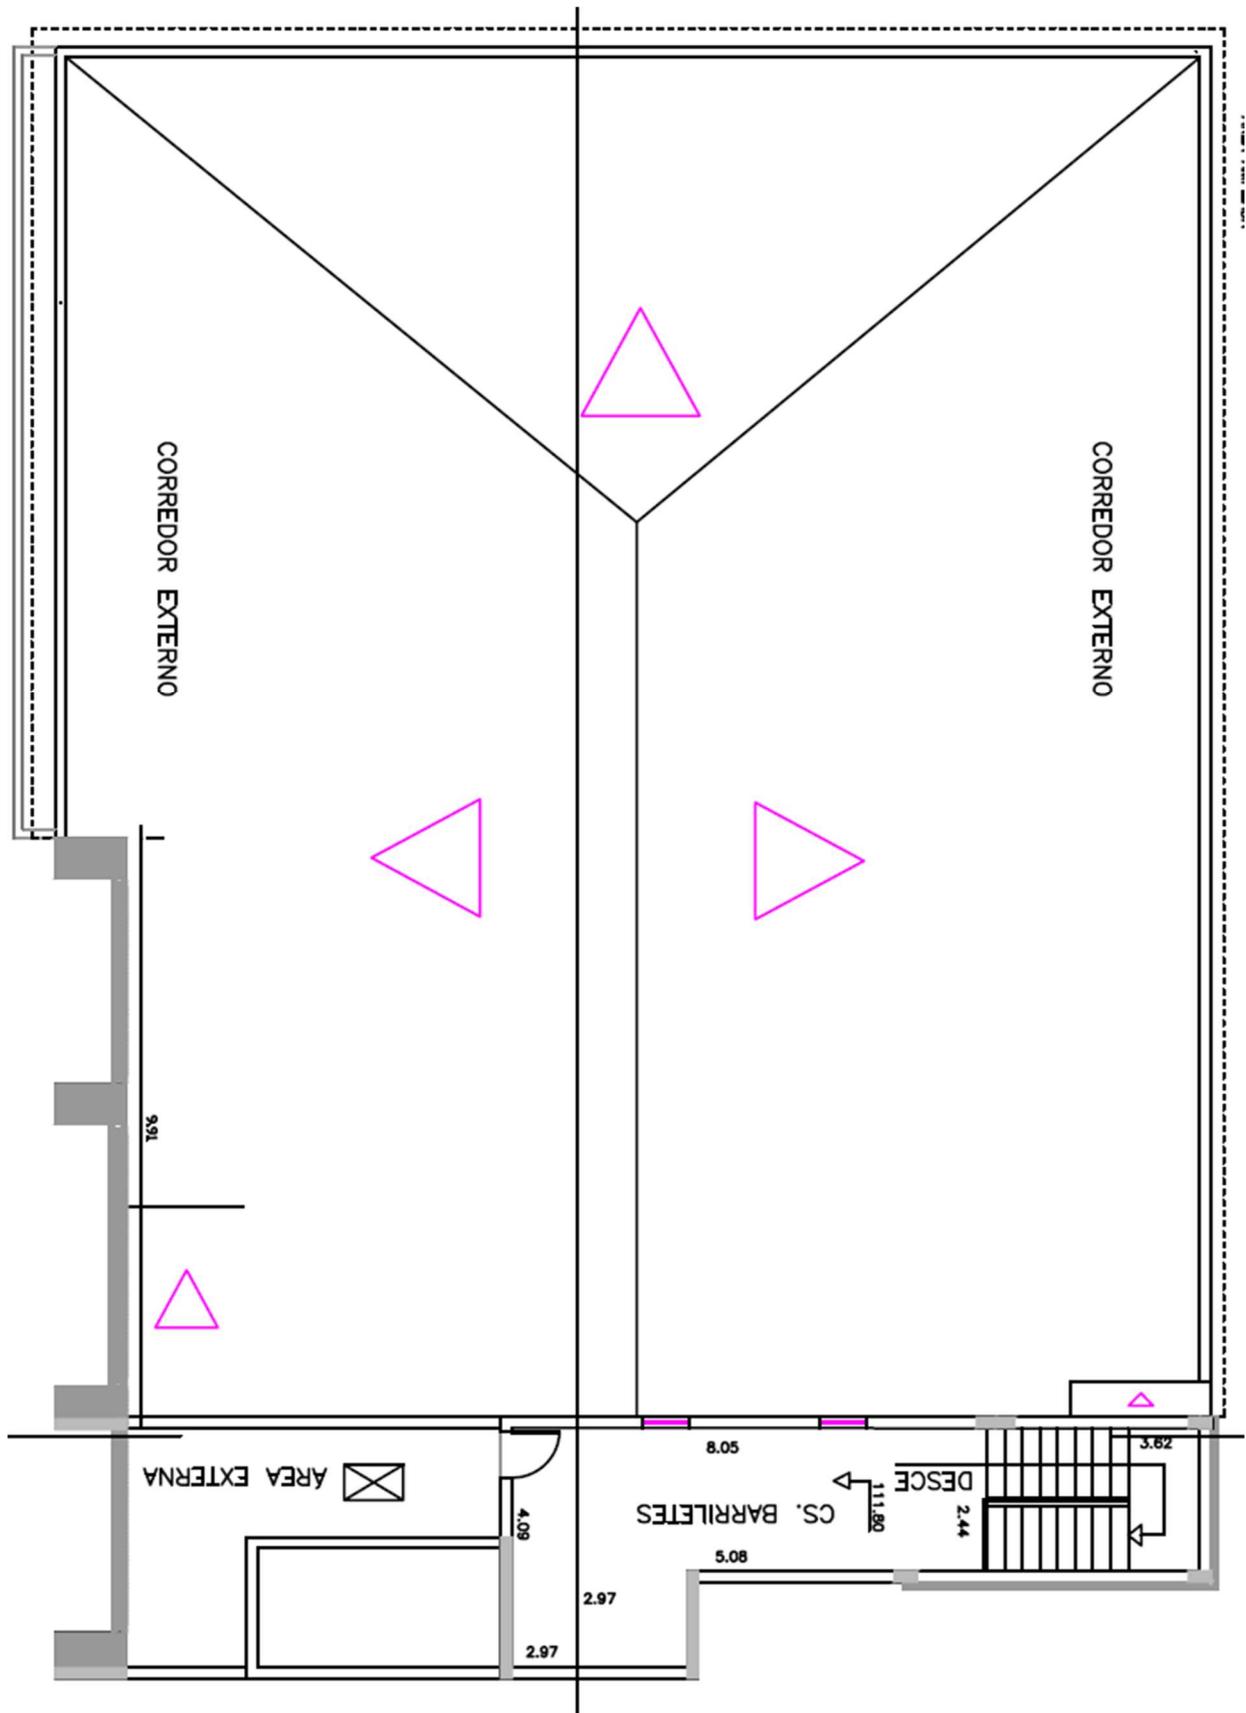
Perspectiva Geral do Telhado e Último Pavimento
